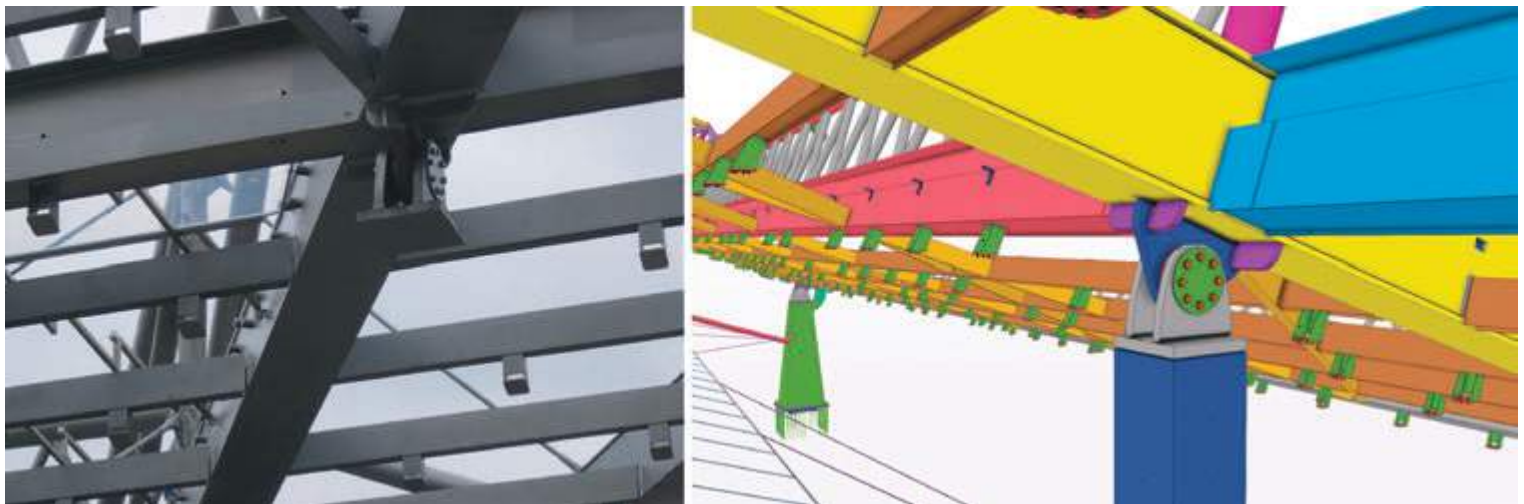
| Dettagli nodi sferici in corrispondenza del collegamento della Struttura Primaria – Totem
